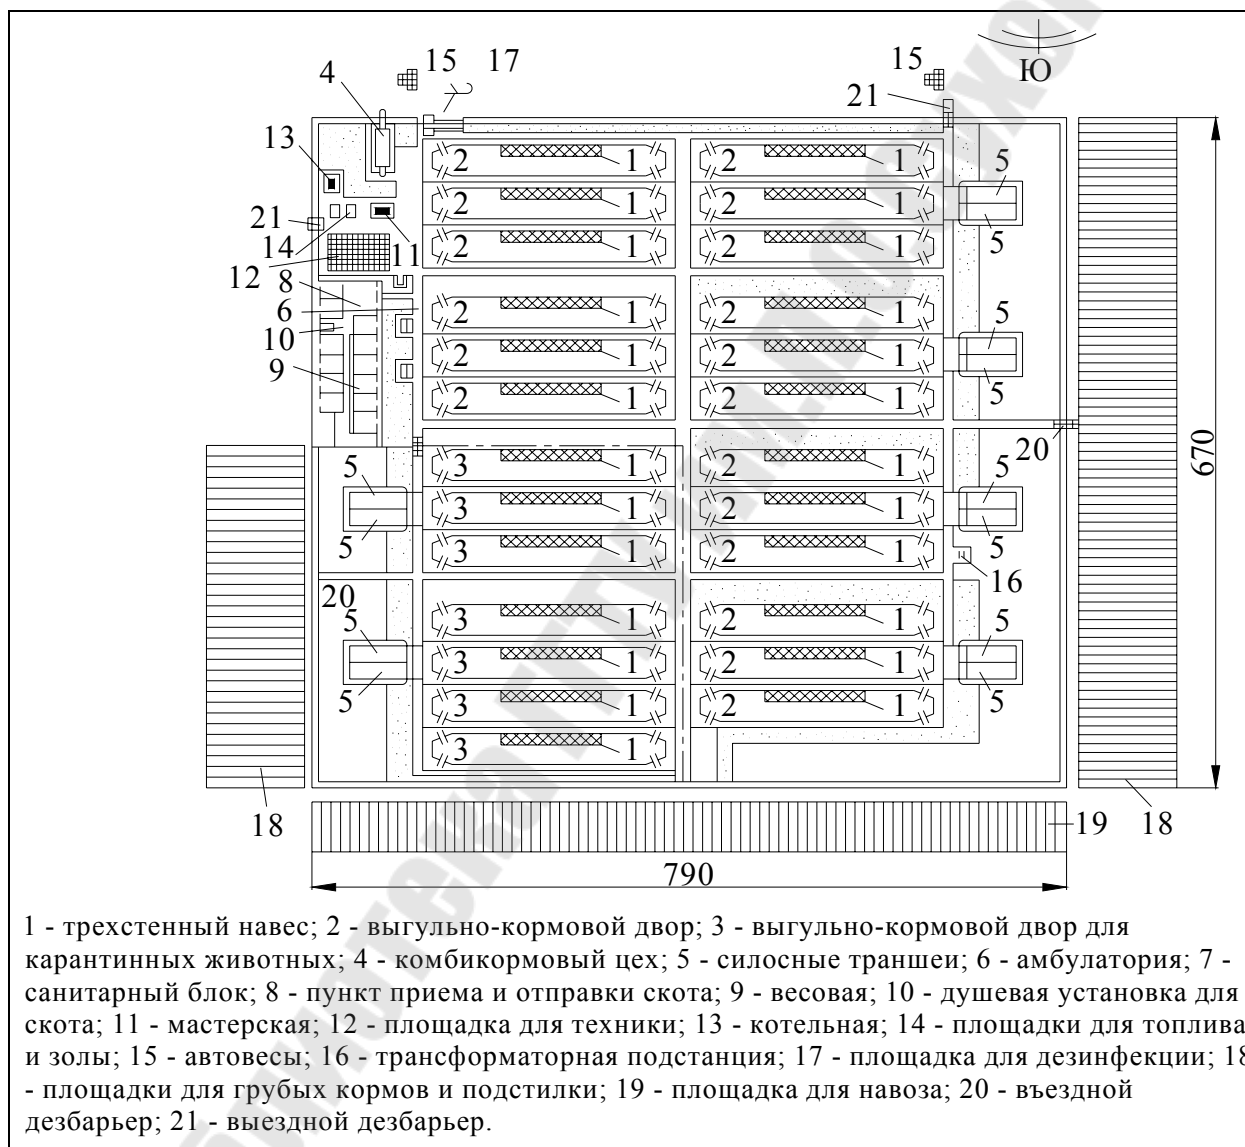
Схема открытой площадки для откорма 10 000 голов крупного рогатого скота
